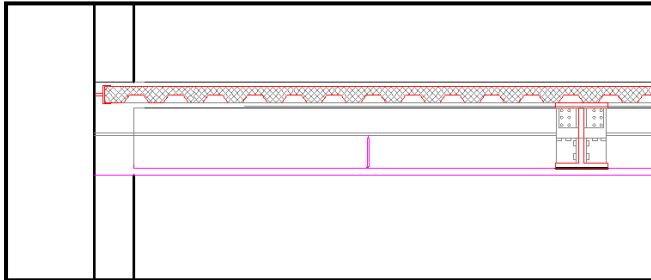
coupe illustrant détail du plancher collaborant de la tour
